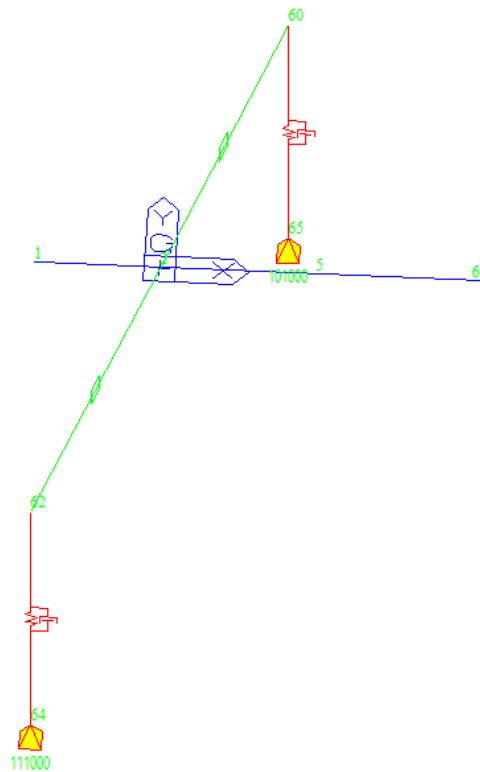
MODELLAZIONE SPALLA CON PAL
